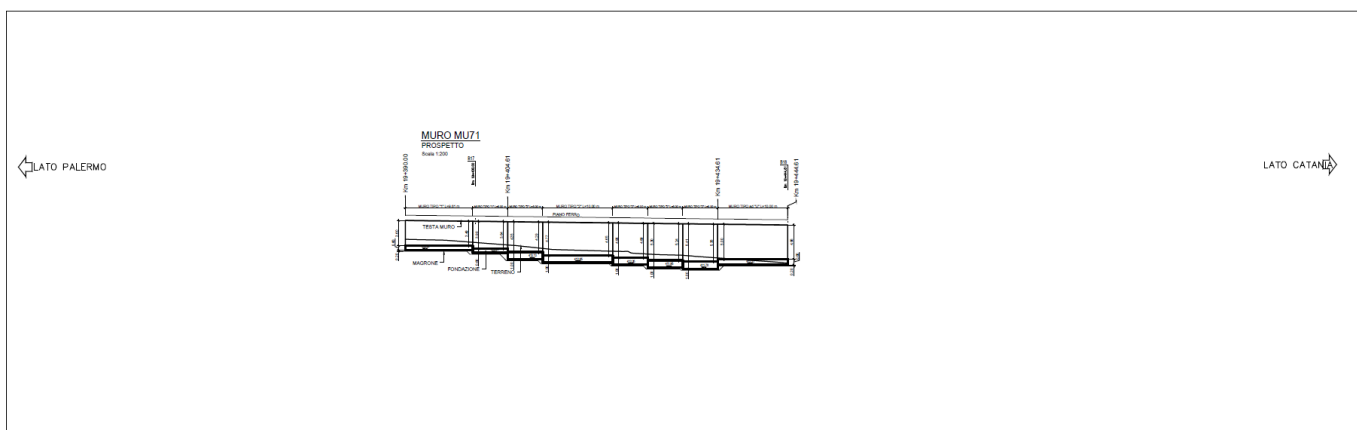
RI08: Muro di sostegno MU71 - Prospetto.
